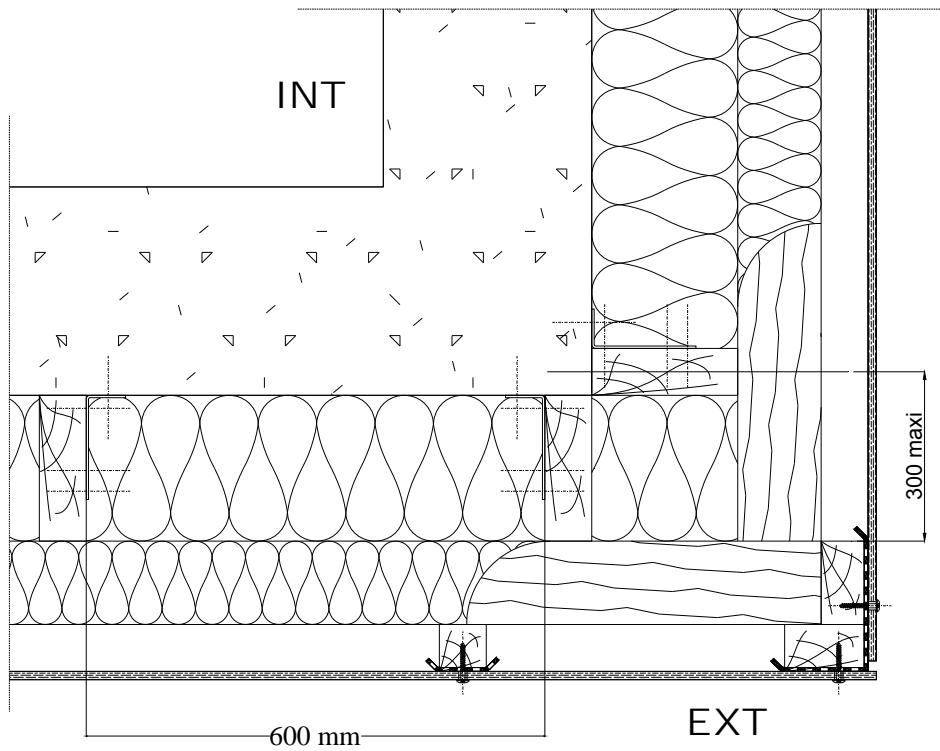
Réseaux croisés sur BA - Coupe horizontale angle sortant
